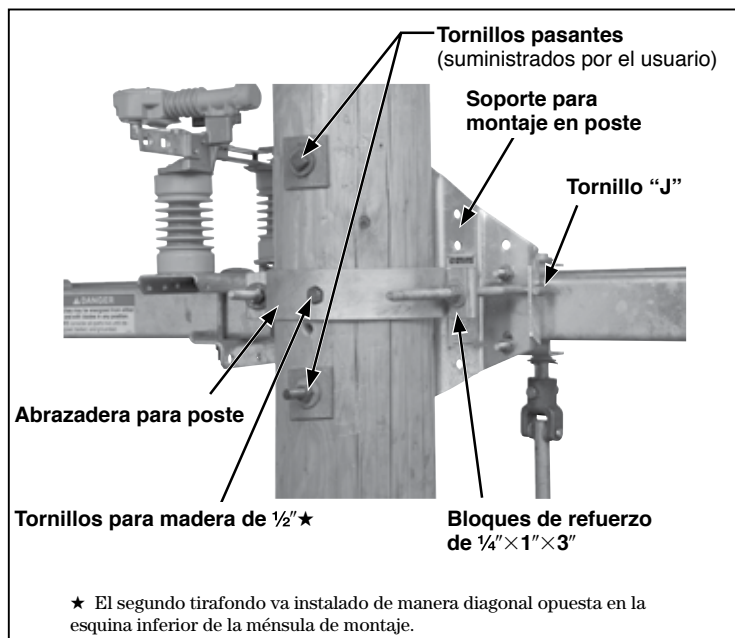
Detalle típico de la fijación de la abrazadera para poste (se ilustra la configuración de montaje horizontal).
